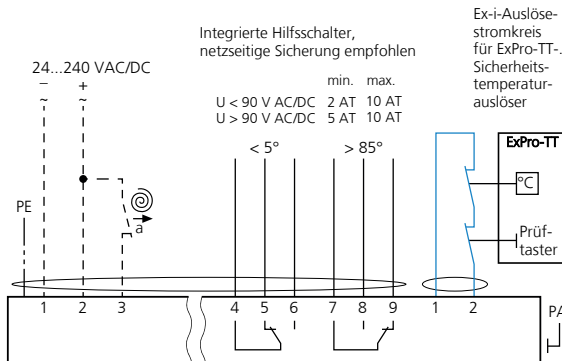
SB7.4 - Kabeltyp 9+PE, Kabeldurchmesser 8,8 mm
